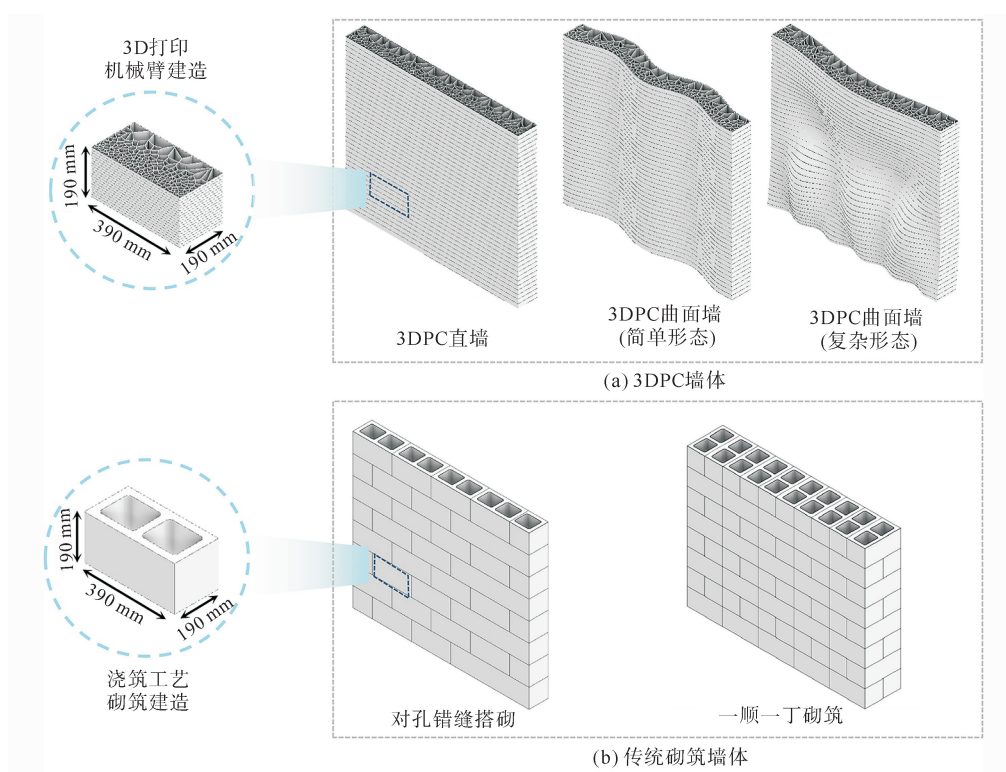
3DPC 墙体与混凝土墙体基本构件及建造方式的对比示意
